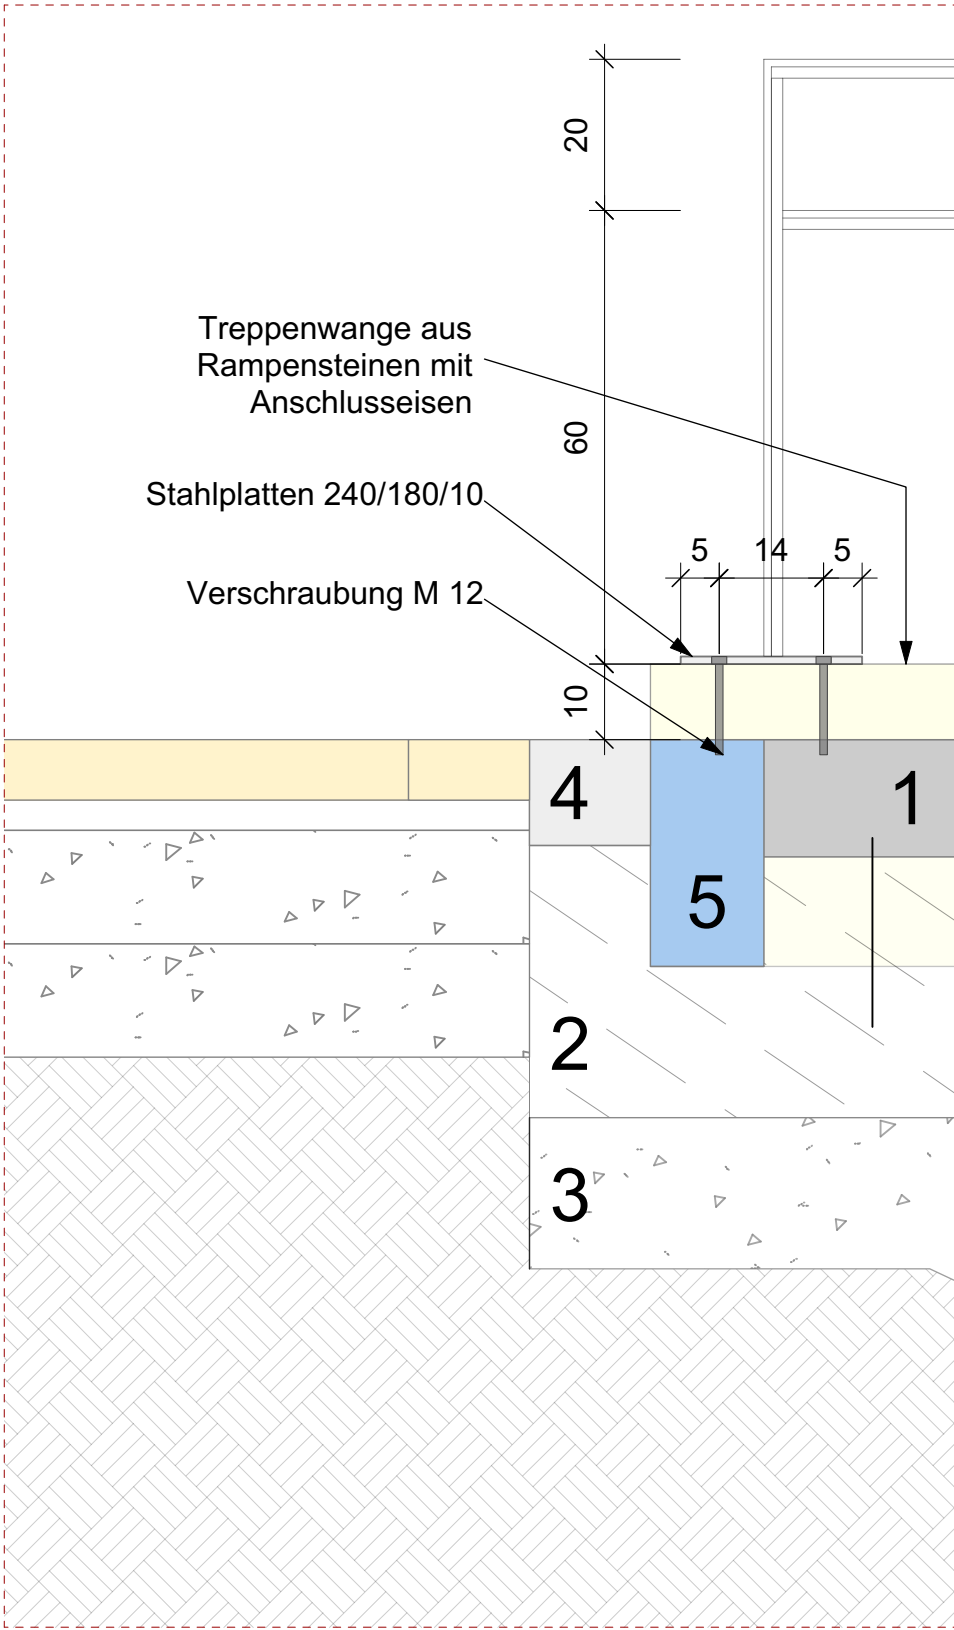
\_Detail Konstruktion Geländer Verbindungstreppe
